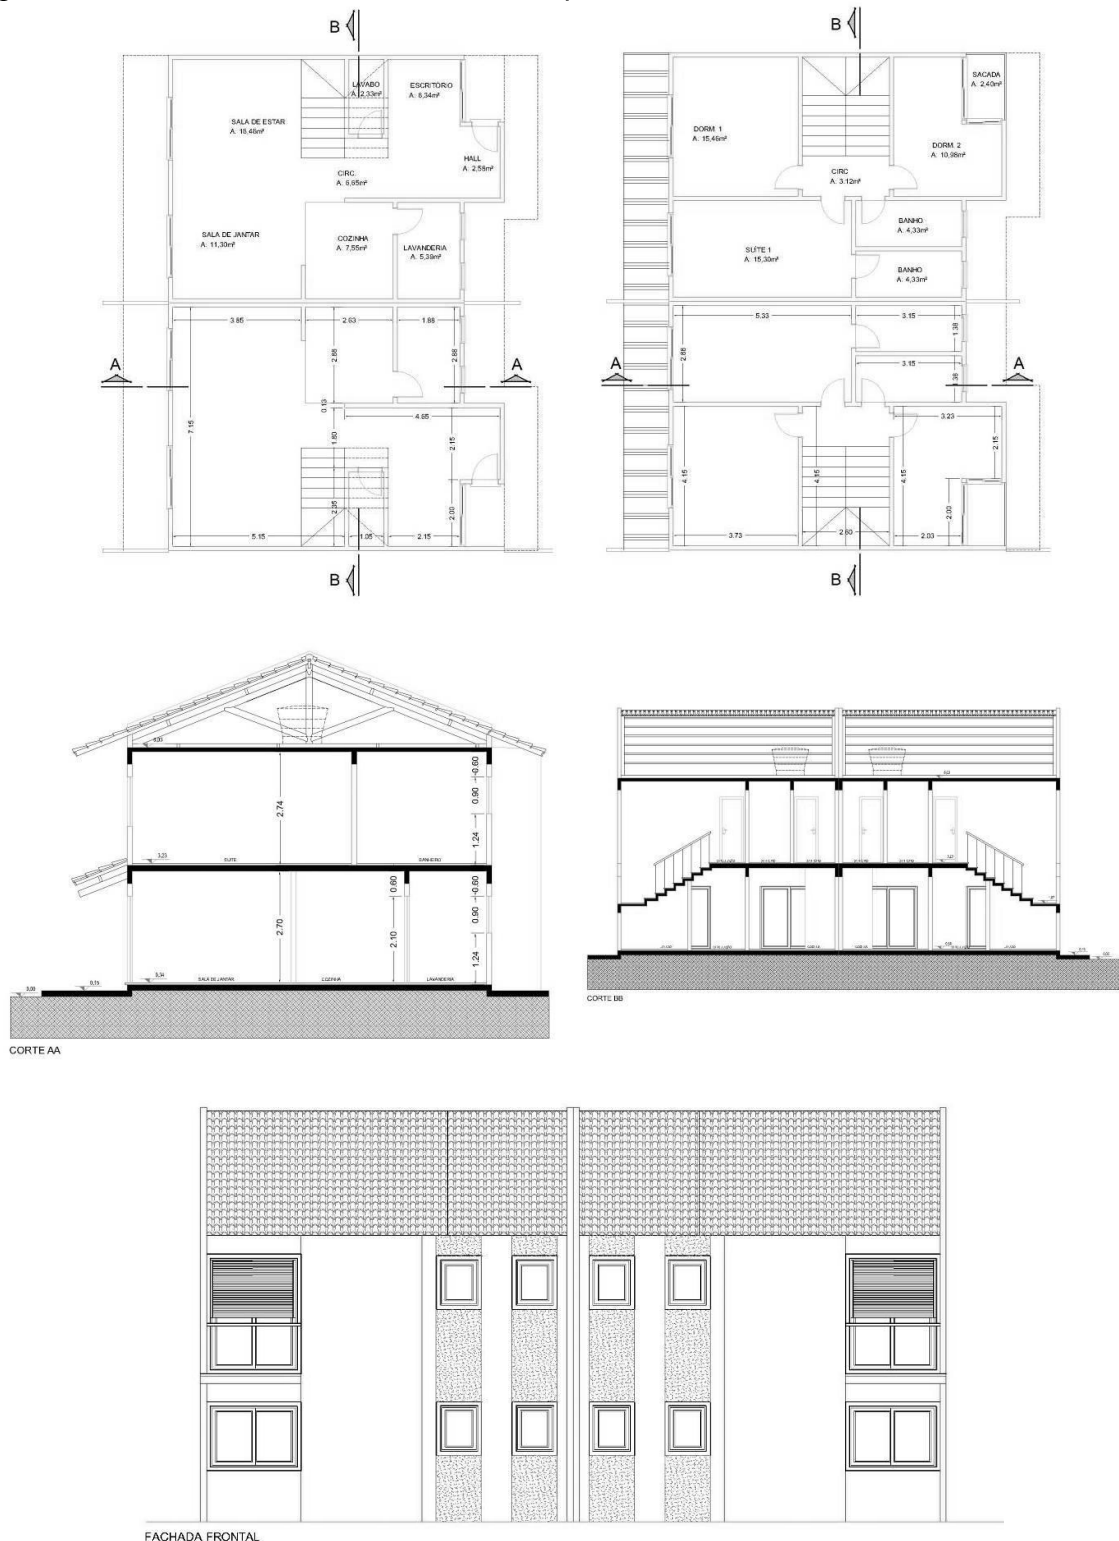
Planta baixa, corte e fachada principal da edificação tipo UH2
